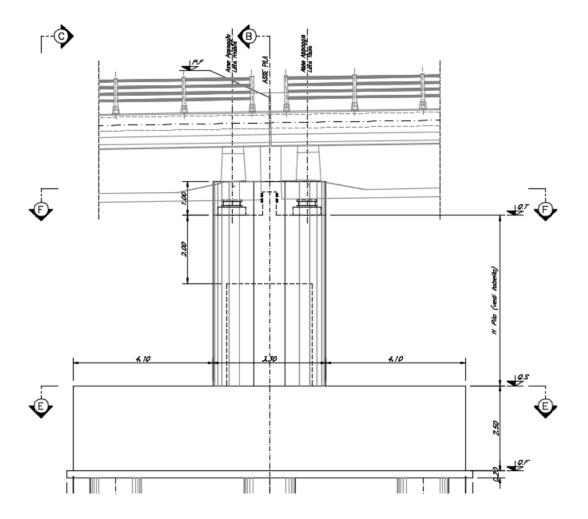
Pila scatolare singolo binario – prospetto longitudinale
